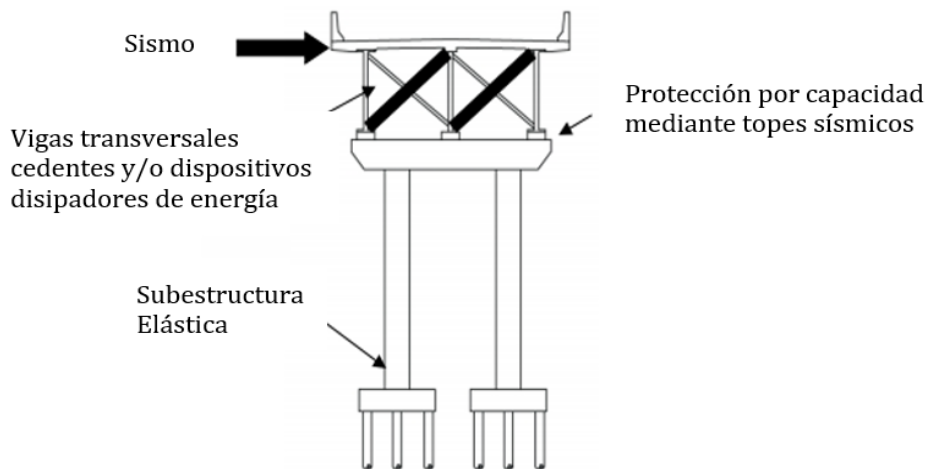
Subestructura Elástica con Superestructura Dúctil
